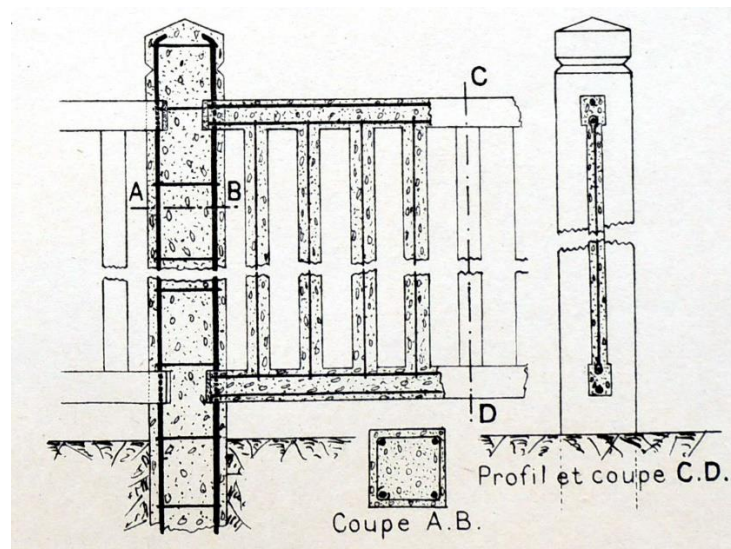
Ejemplo de la armadura interna de una barandilla de hormigón armado.
